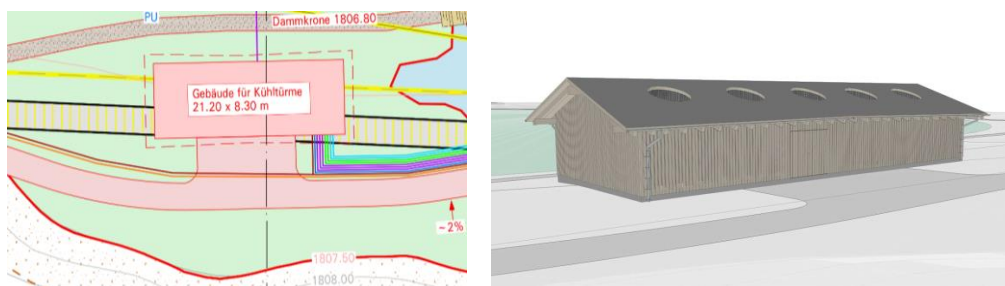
neues Betriebsgebäude für Kühltürme, Ausschnitt Situationsplan Bauprojekt und 3d-Ansicht Baueingabeplan (Quelle: Steiger Ingenieure + Planer AG, Reichenbach Architekten AG)
